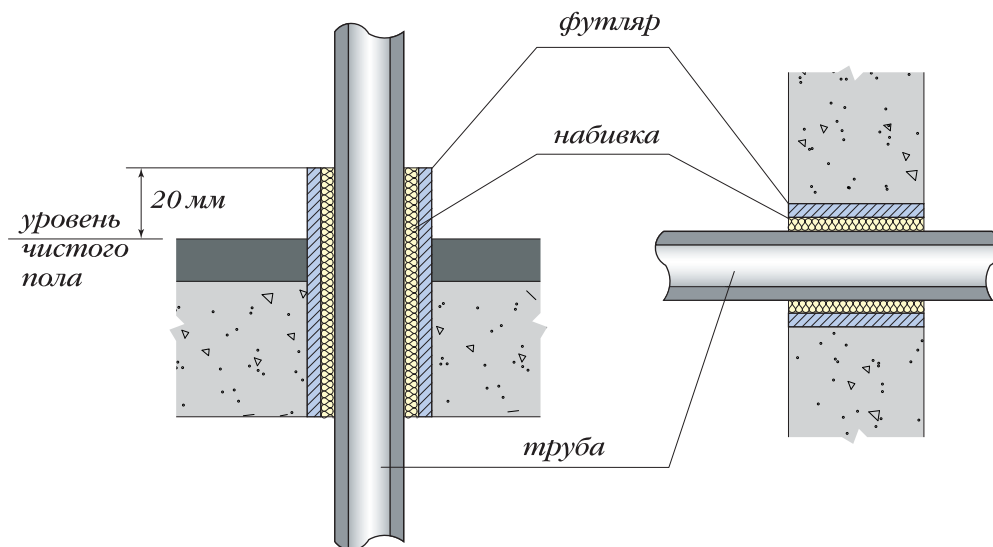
Проход полимерных трубопроводов через перекрытие и стену
